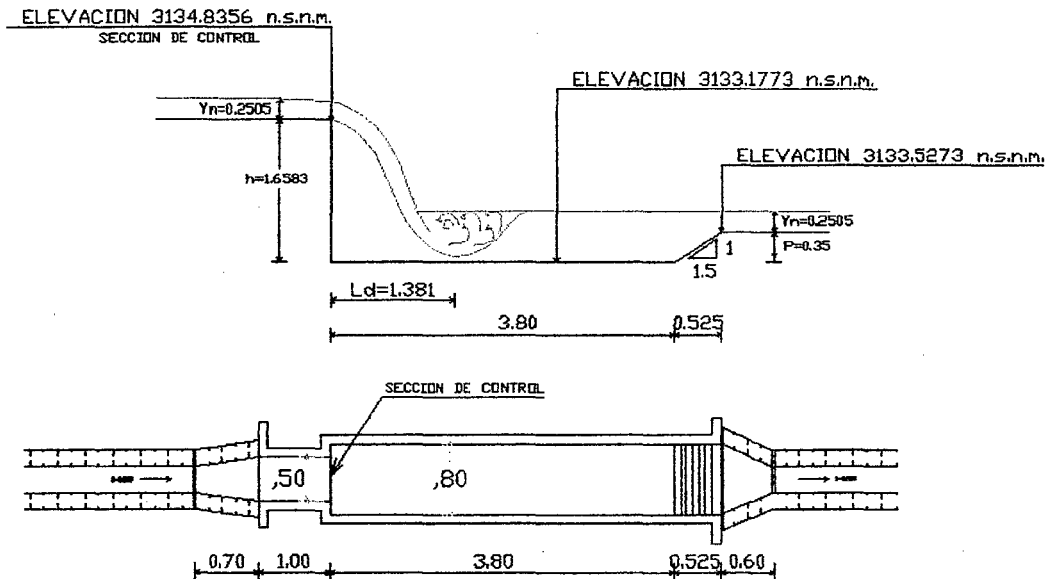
CAIDA VERTICAL PLANTA Y PERFIL
